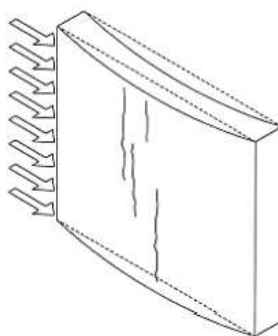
Fisuras verticales por esfuerzos horizontales
